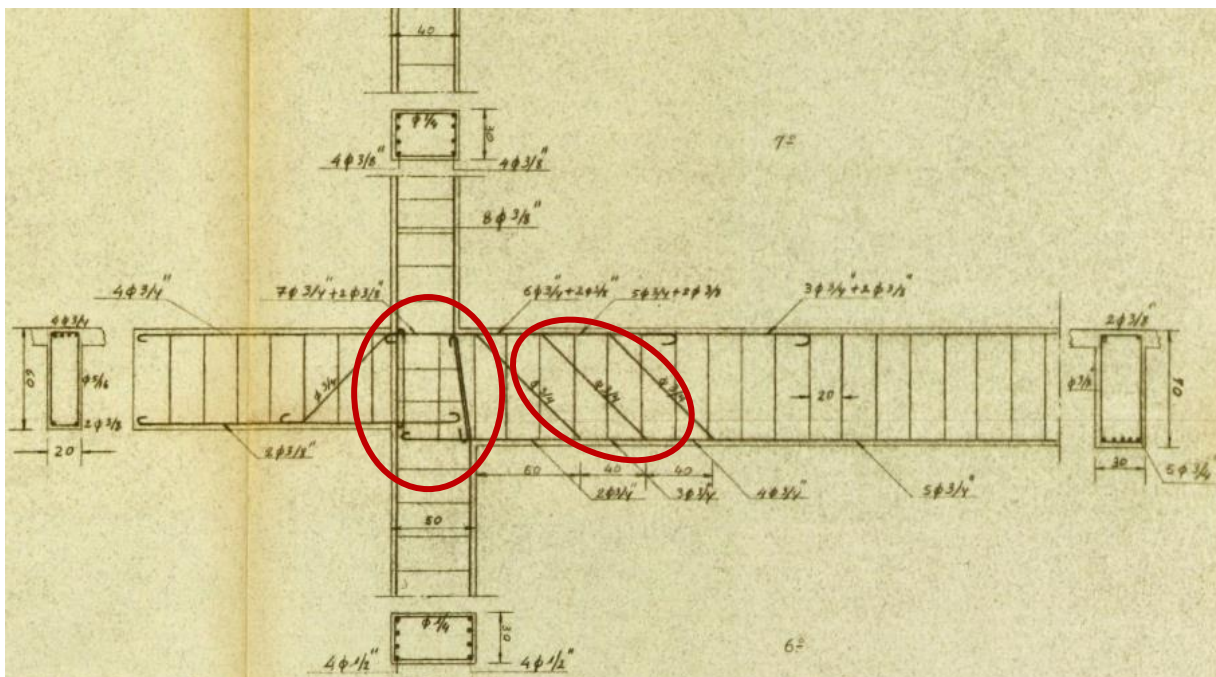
Peça desenhada do pormenor da ligação de um pórtico tipo. (Fonte: [35])
